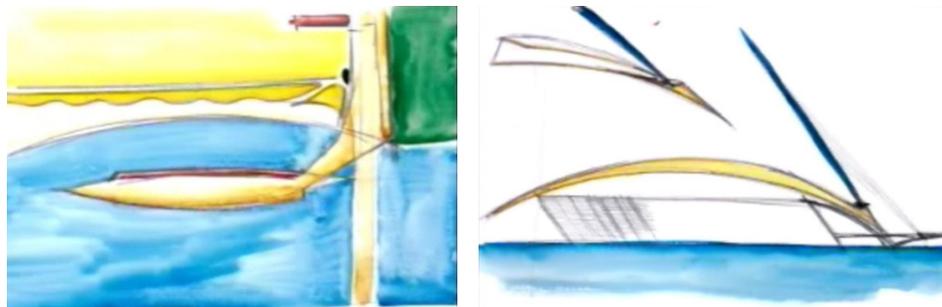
Marina d'Arechi, seconda ipotesi progettuale, schizzi ad acquerello realizzati dal progettista Santiago Calatrava
